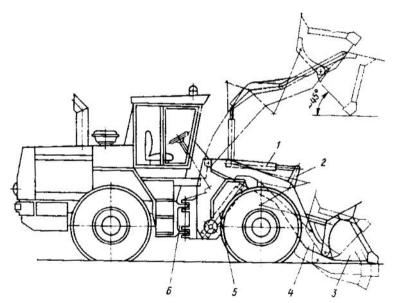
Одноковшовый фронтальный погрузчик с шарнирно-сочлененной рамой: 1 – гидроцилиндр управления ковшом; 2 – шарнирно-рычажная система поворота ковша: 3 – ковш; 4 – стрела; 5 – гидроцилиндр подъема стрелы; 6 – шарнирное сочленение рамы
